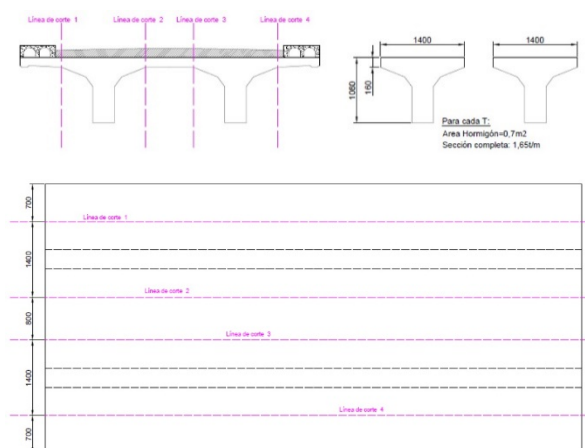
Cortes en la viga para obtener las vigas en T completas.
